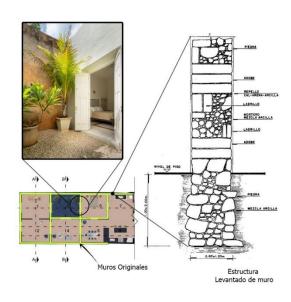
Análisis Estructural Casa E/A Fuente: Elaboración Propia
